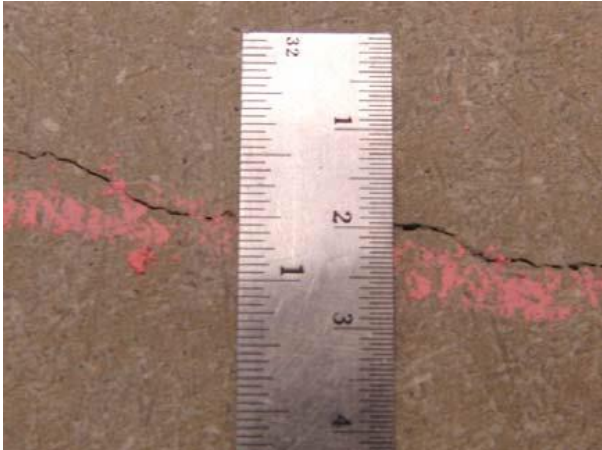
Levantamiento de fisuras en la losa de planta baja a 25/01/2013 (AICEQUIP, (2013)).
